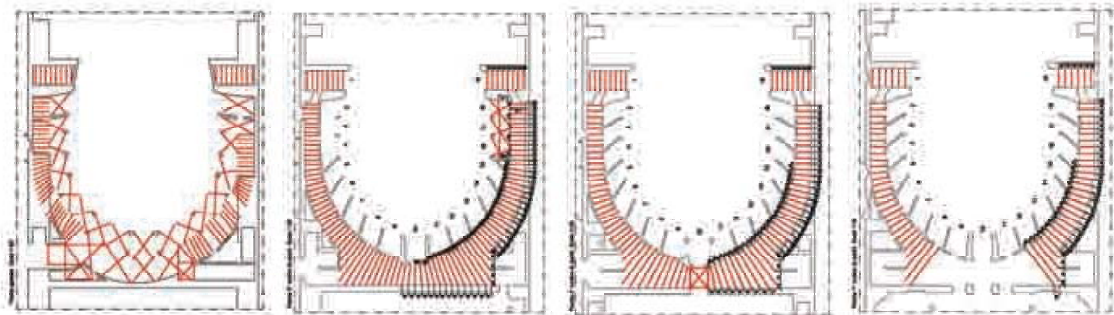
Piante delle griglie di rinforzo disposte ai quattro piani.
